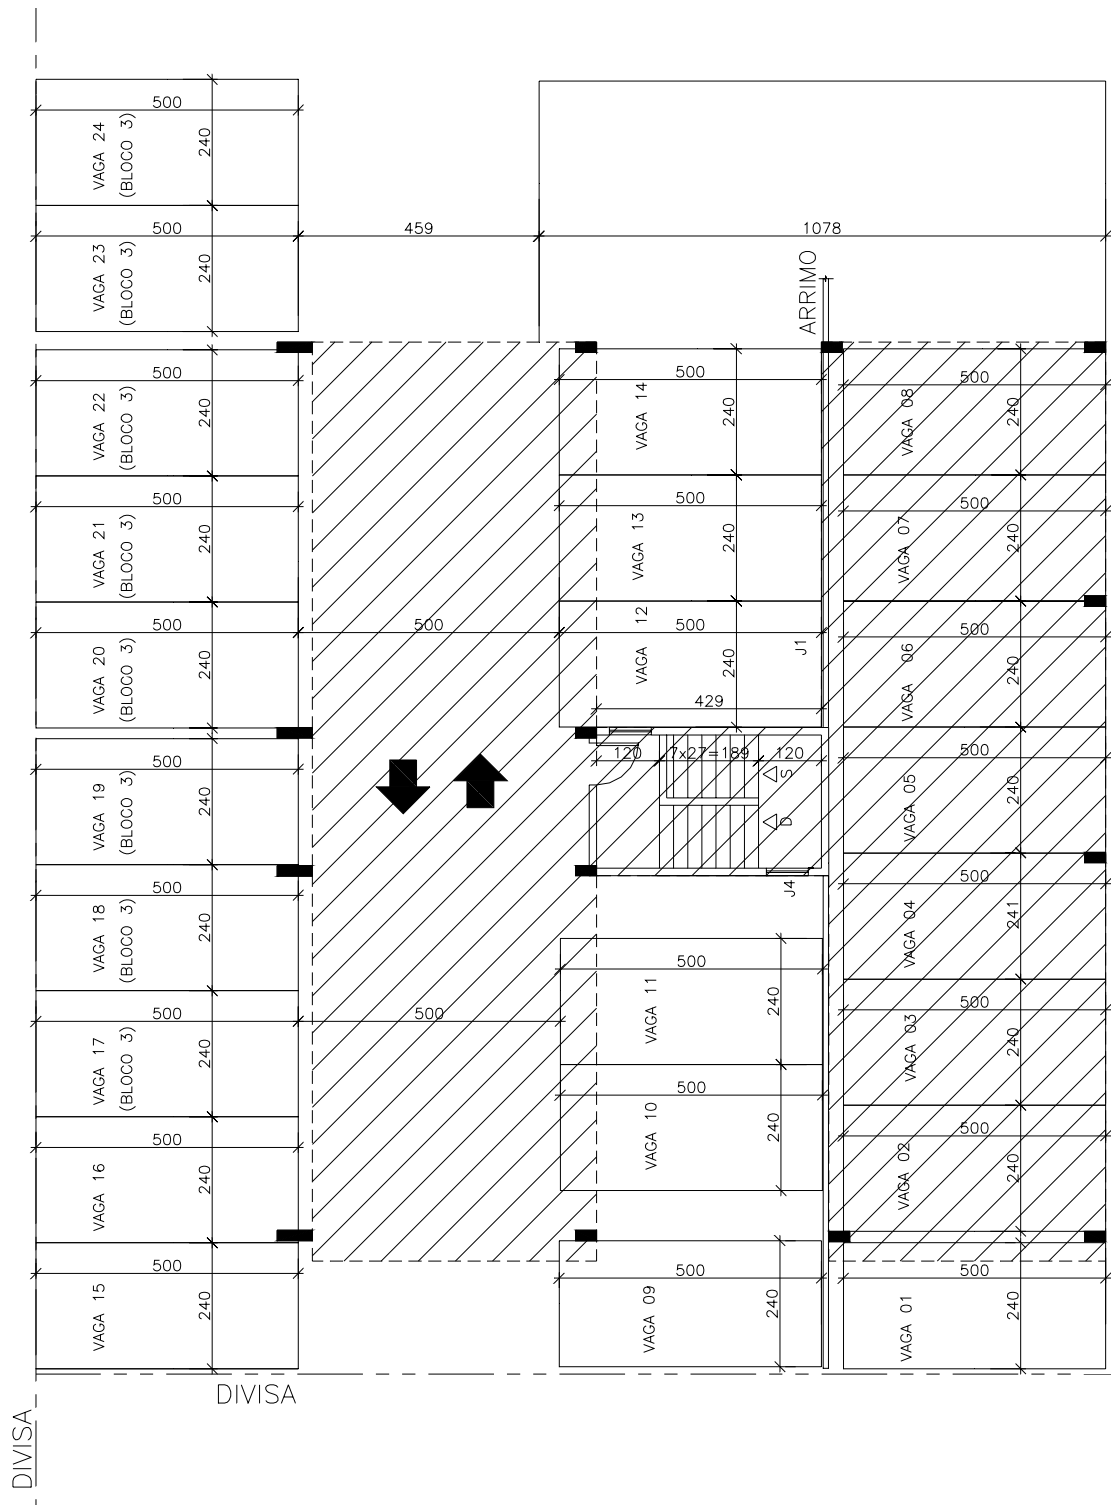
Residencial “J” – Bloco 4 – Projeção do pavimento tipo sobre as garagens
